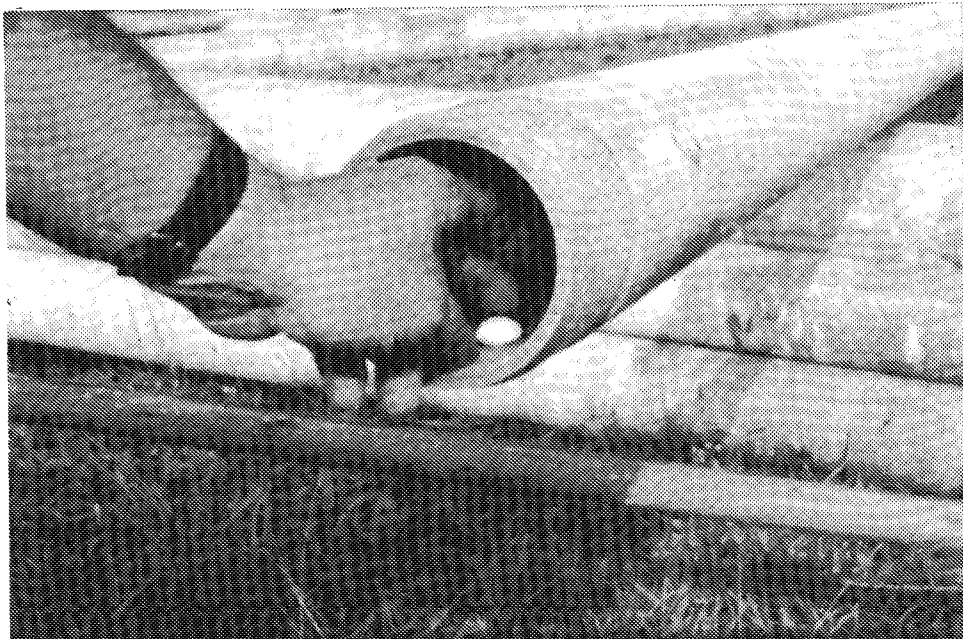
Het plakken van calciumhypochloriettabletten in geborstelde buizen. Na het leggen wordt de leiding een halve slag gedraaid, zodat de tablet aan de bovenkant van de leiding zit.
